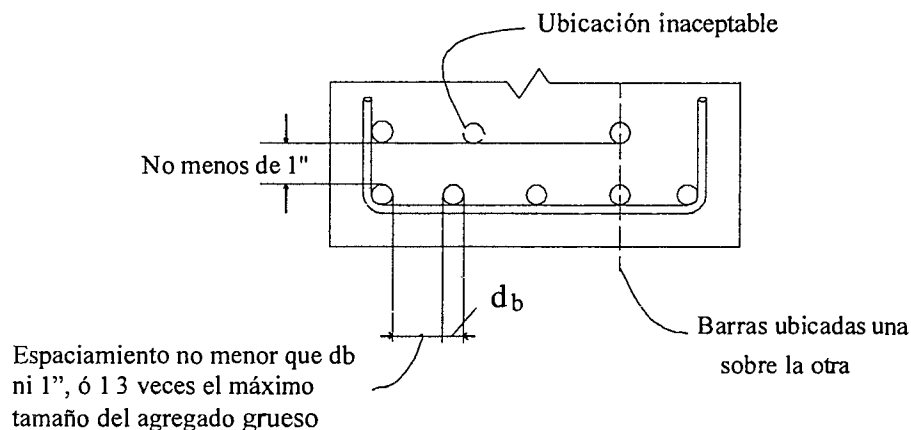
Espaciamientos mínimos en armaduras de vigas
